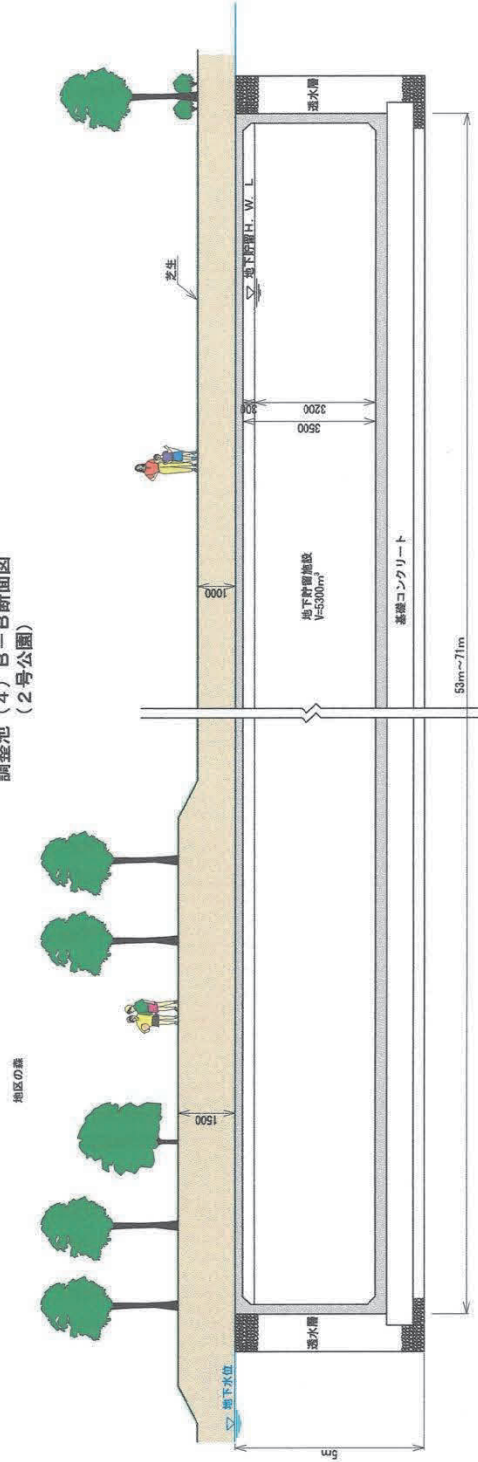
(2) 調整池 (4) 断面図 (2号公園)
